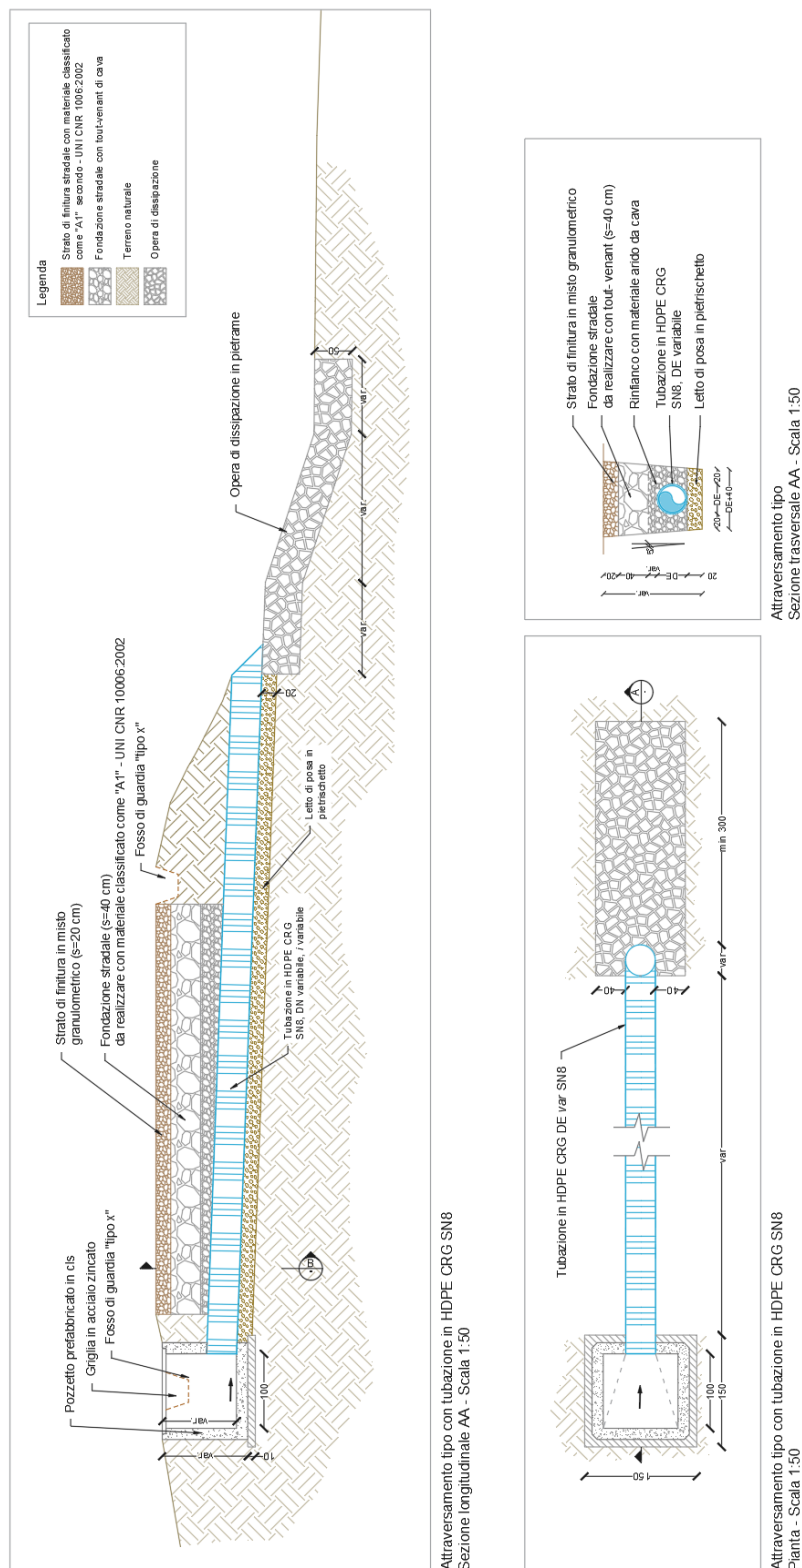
Sezioni longitudinali, trasversali e pianta dell'attraversamento tipo.
